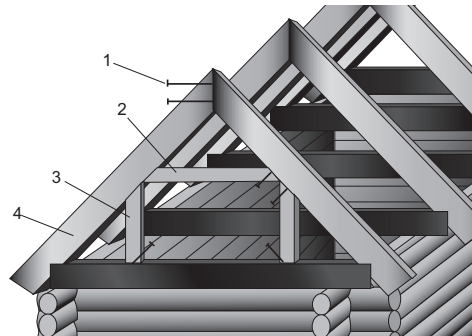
Установка поперечных планок и подпорок: 1 — места крепления саморезами; 2 — поперечная планка; 3 — подпорка; 4 — стропильная ферма
